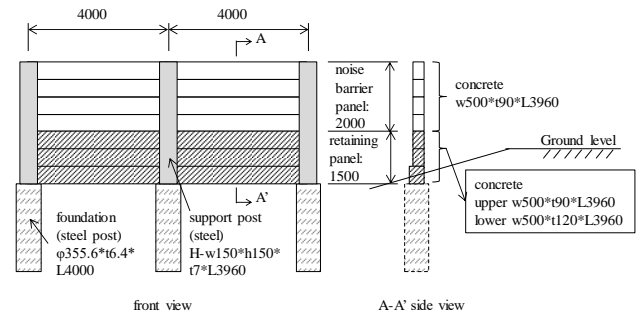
遮音壁の構造模式図 (コンクリート製) (単位: mm)
